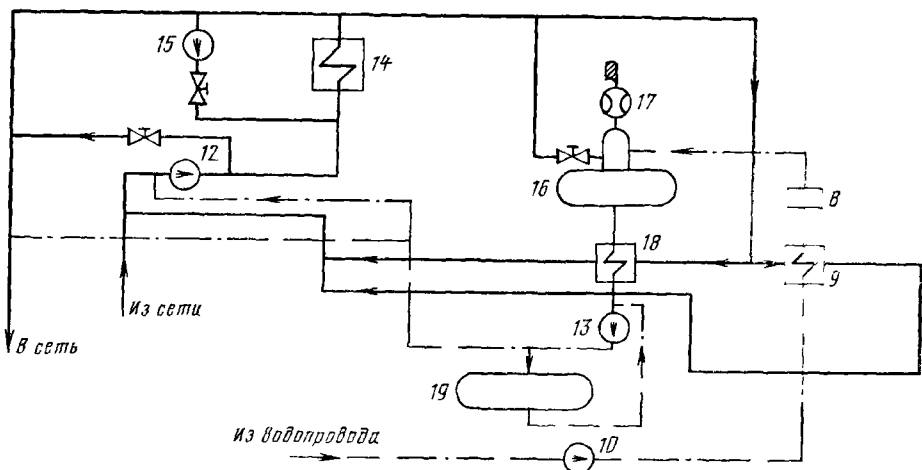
Принципиальная схема отопительной водогрейной котельной с отпуском тепла при открытой системе теплоснабжения.
